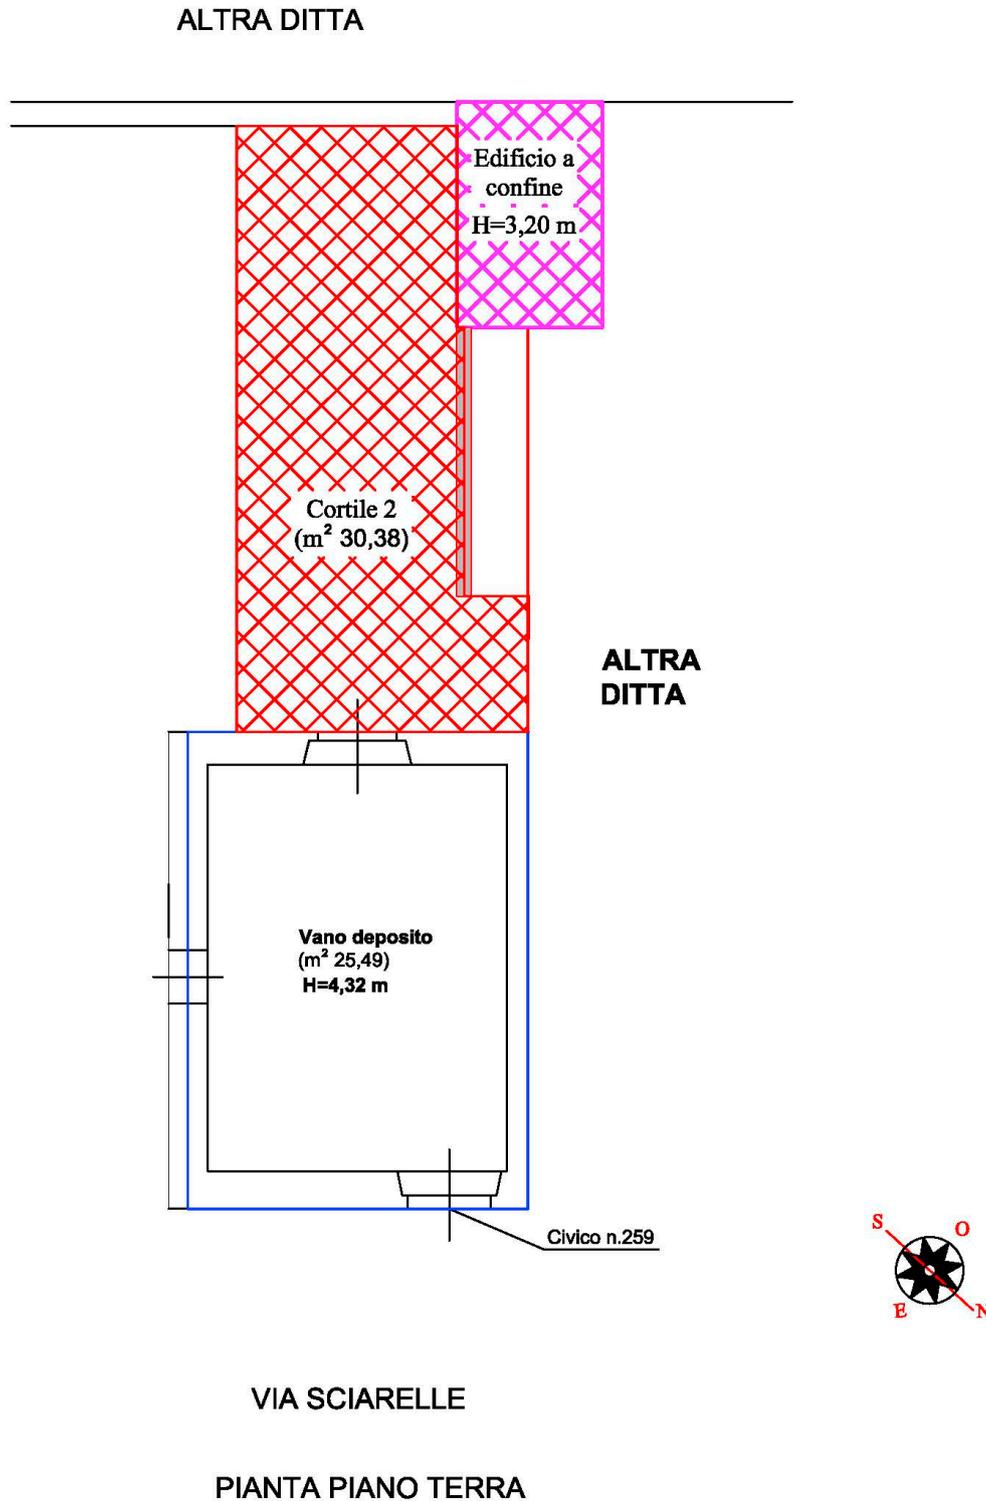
Planimetria pianta piano terra Unità Immobiliare I2
